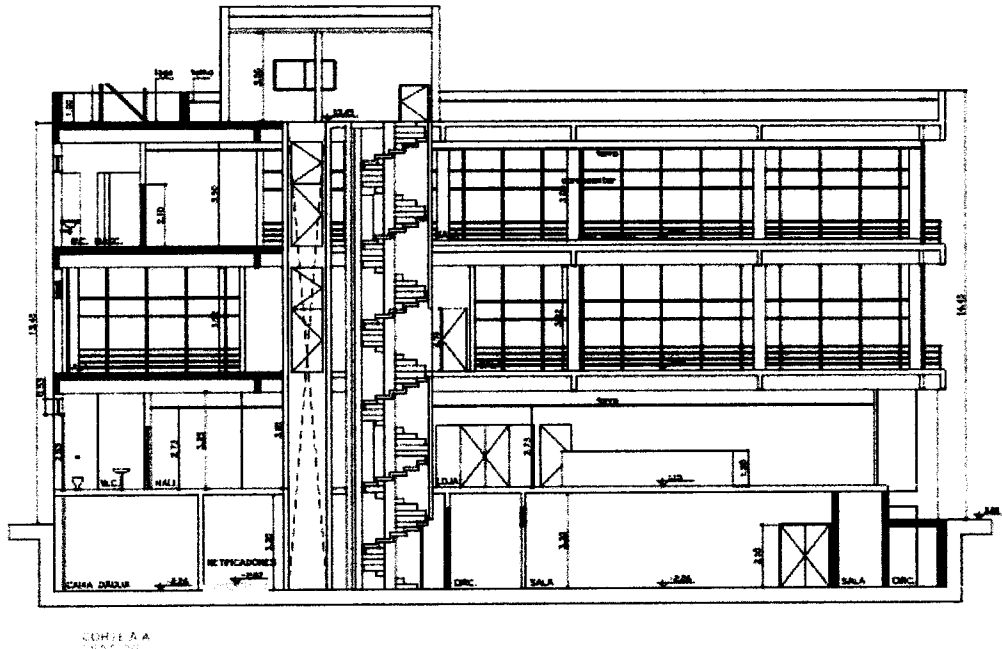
Corte Longitudinal do Edifício – Centro Cultural
